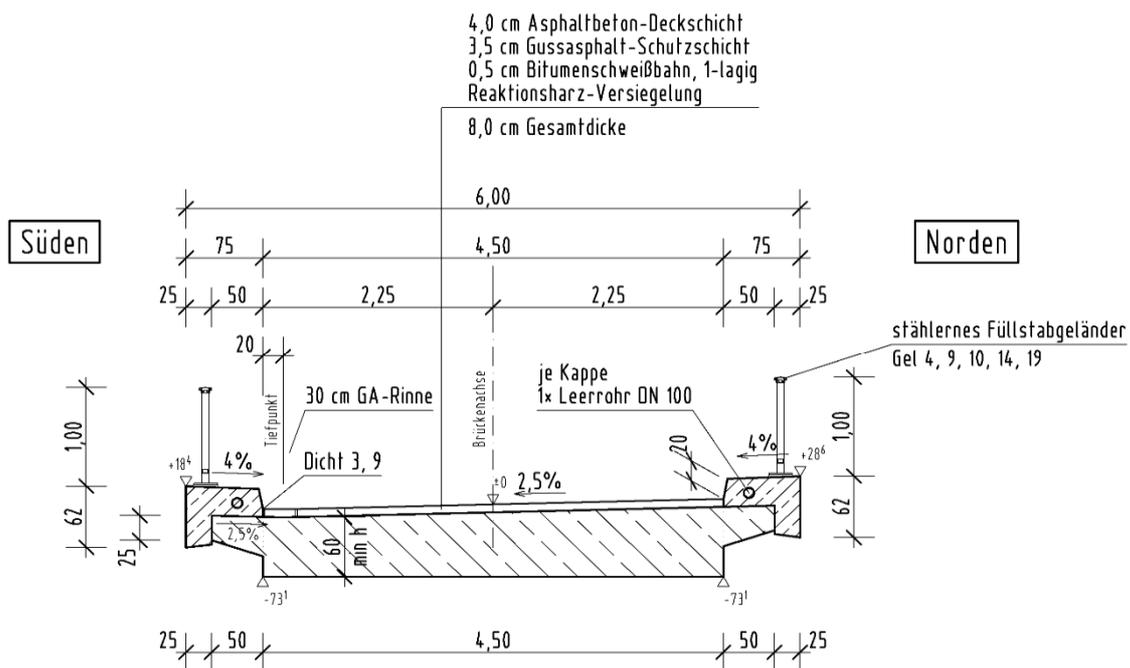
, Überbau als Stahlbetonplatte auf Bohrfahlwänden
